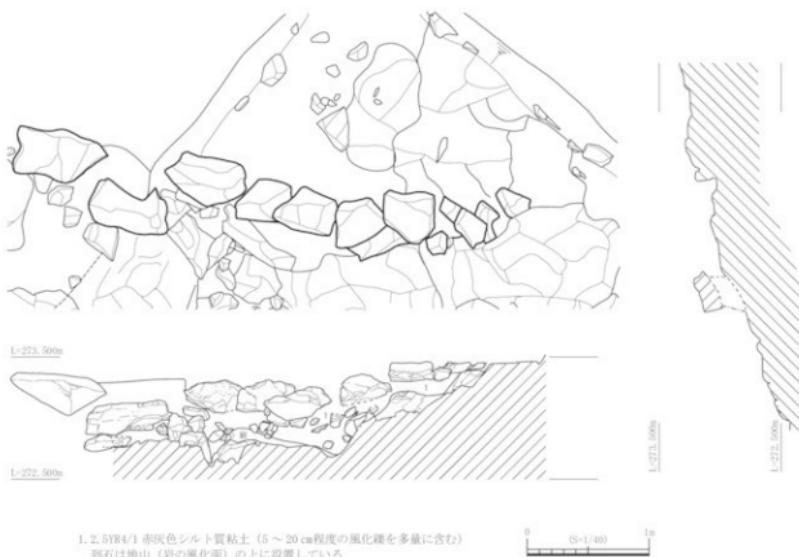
甕城北東部石積み平面図・立面図 ($S = 1/40$)
